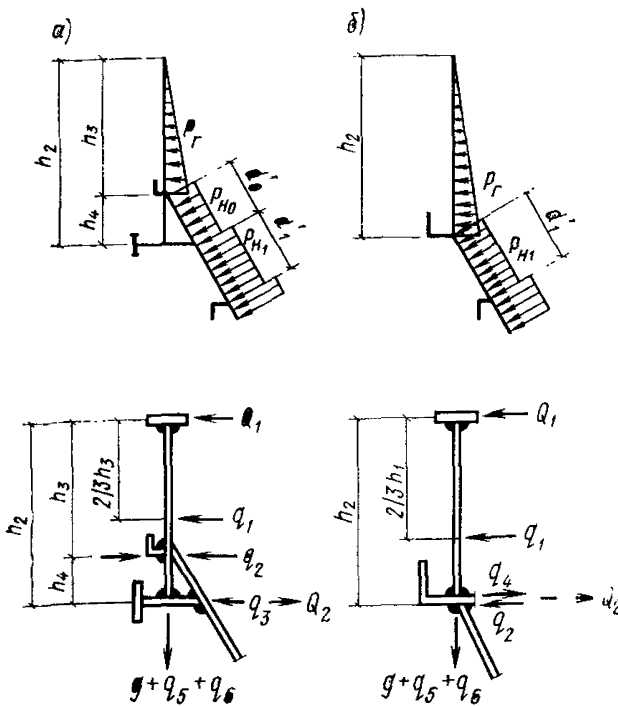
Схема нагрузок на бункерную балку для двух видов узла присоединения воронки
